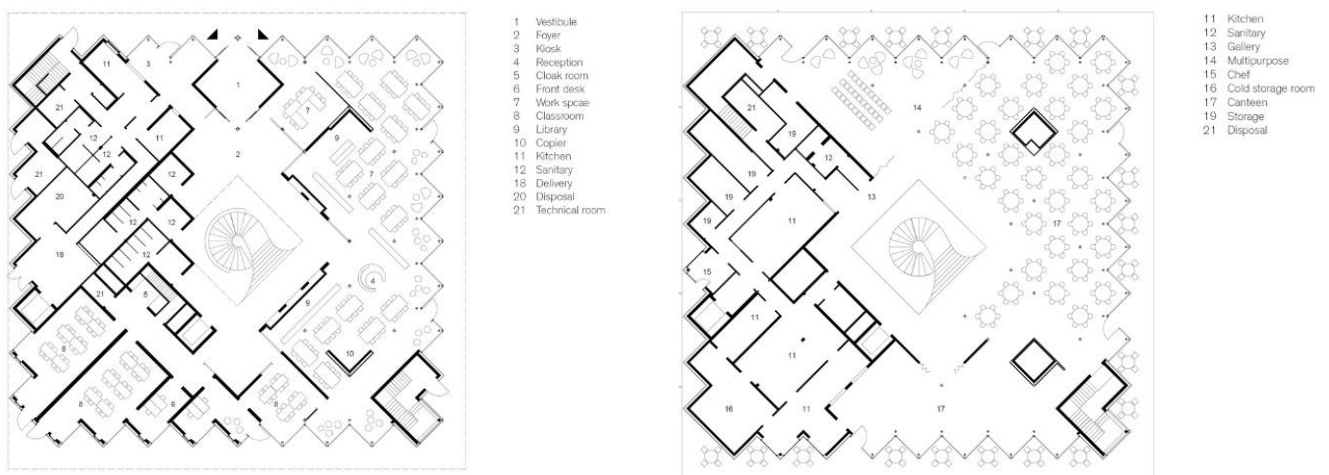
Планування першого [37] та другого поверху [38]
